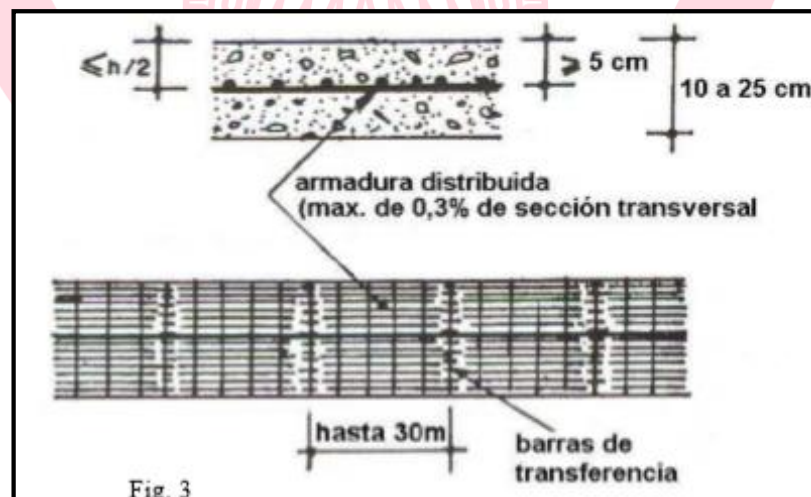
Pavimento de concreto con refuerzo de acero no estructural.
